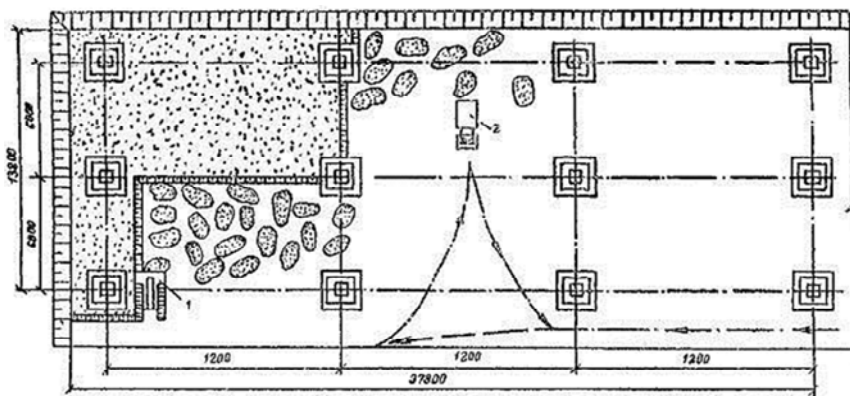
Технологическая схема обратной засыпки и разравнивания грунта в котловане (на примере фрагмента котлована):
